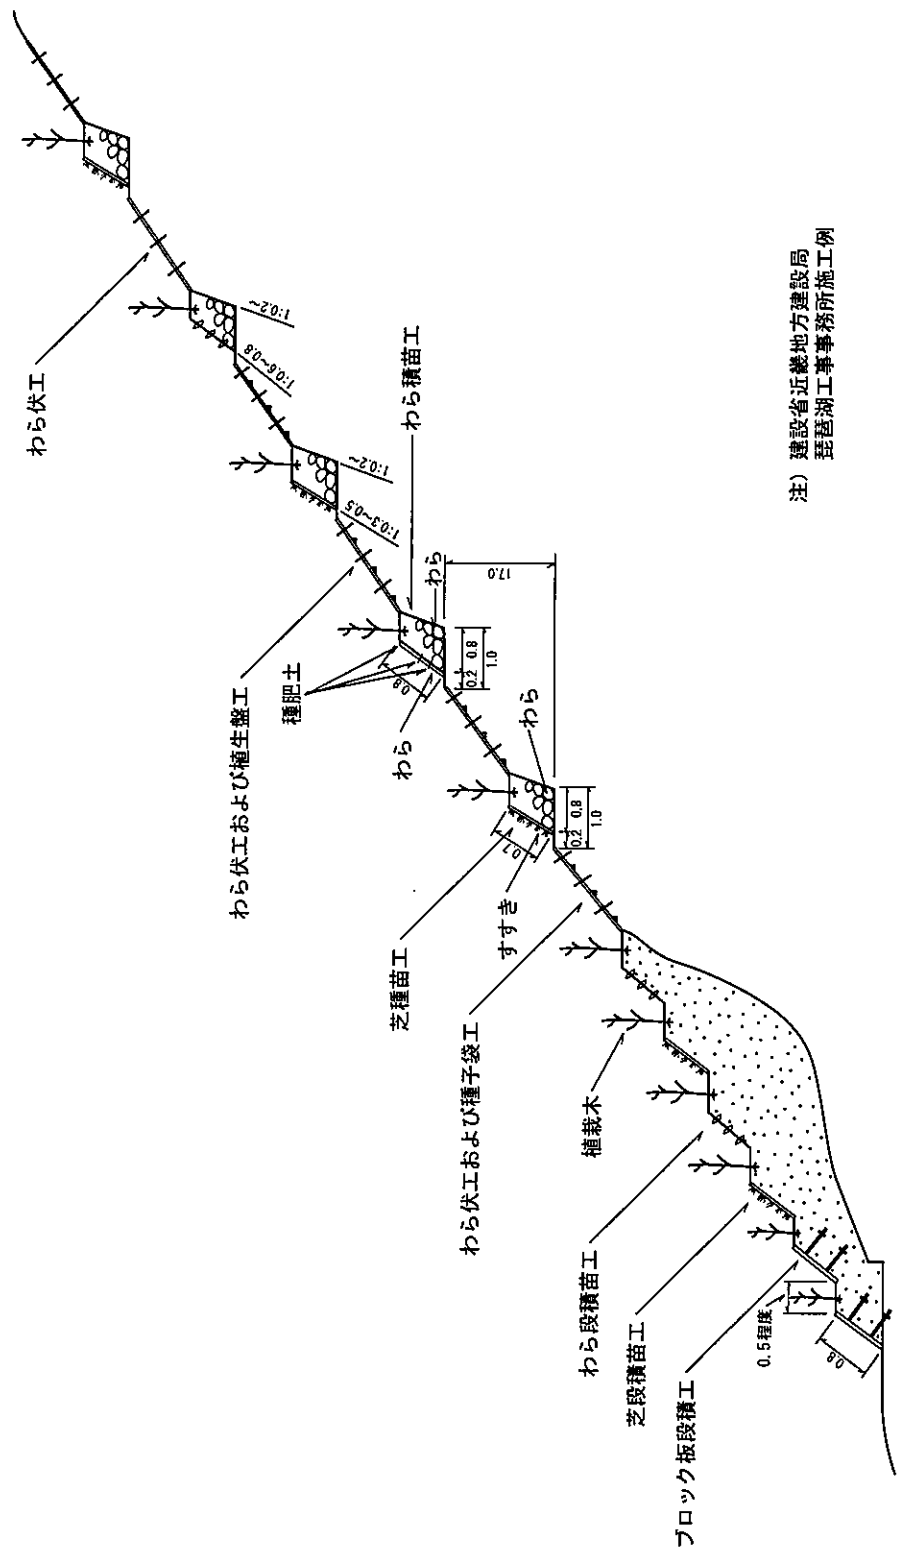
とくしゃ地 (施工例) 断面図 (単位: m)
